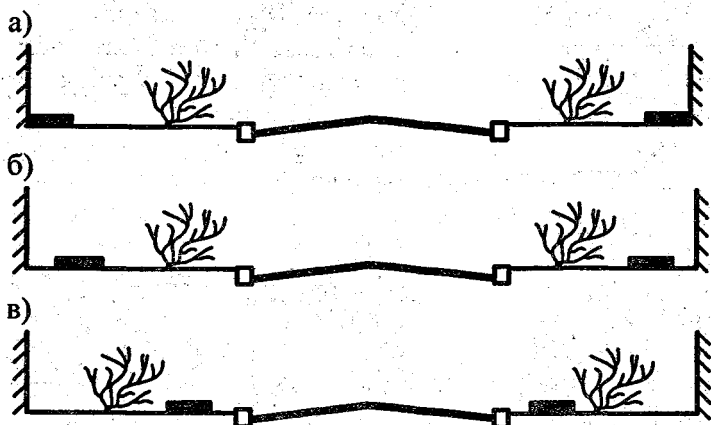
Варианты расположения тротуаров: а) вплотную к зданиям при организованном отводе воды с покрытий; б) при неорганизованном отводе воды с покрытий; в) с разделительной полосой вдоль автомобильной дороги
